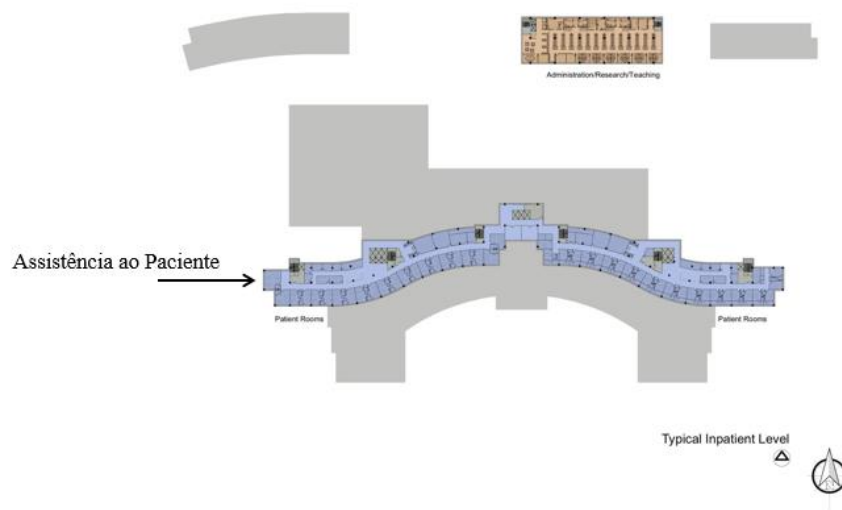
Segundo Pavimento do Hospital Infantil Suzhou.
